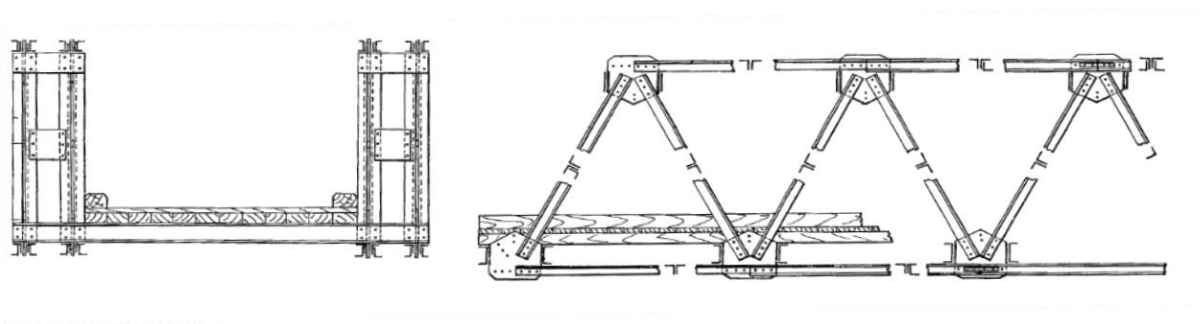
Поперечное сечение и фасад моста Каллендера-Гамильтона [1]
